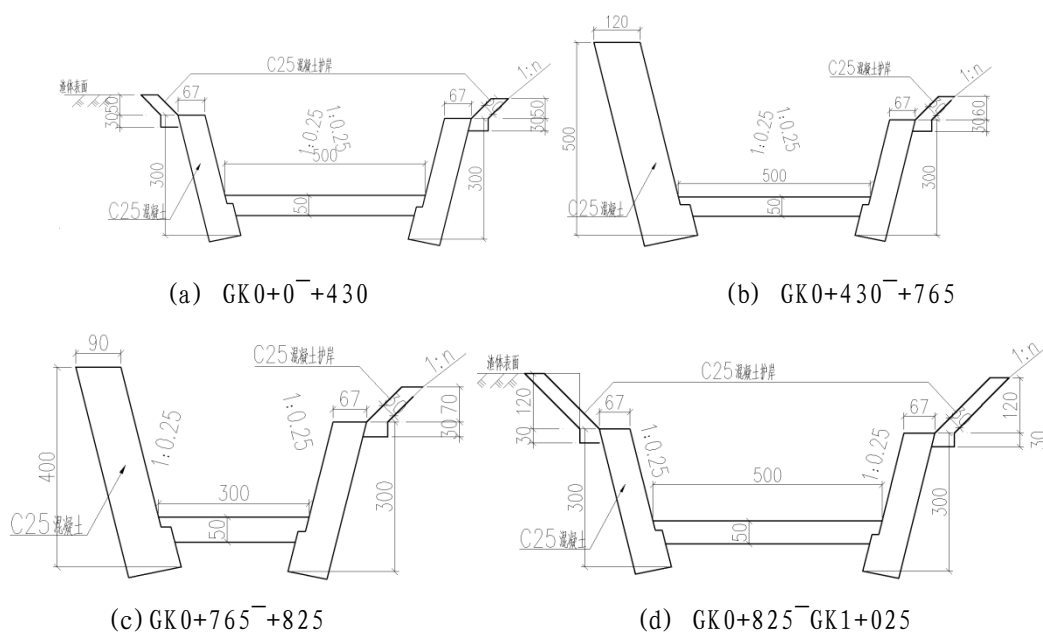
巴东隧道进口渣场改移沟渠剖面图
